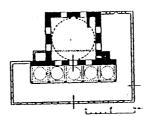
مسقط أفقى لجامع أورخان غازى في جبزه (عن : Kuran) .
